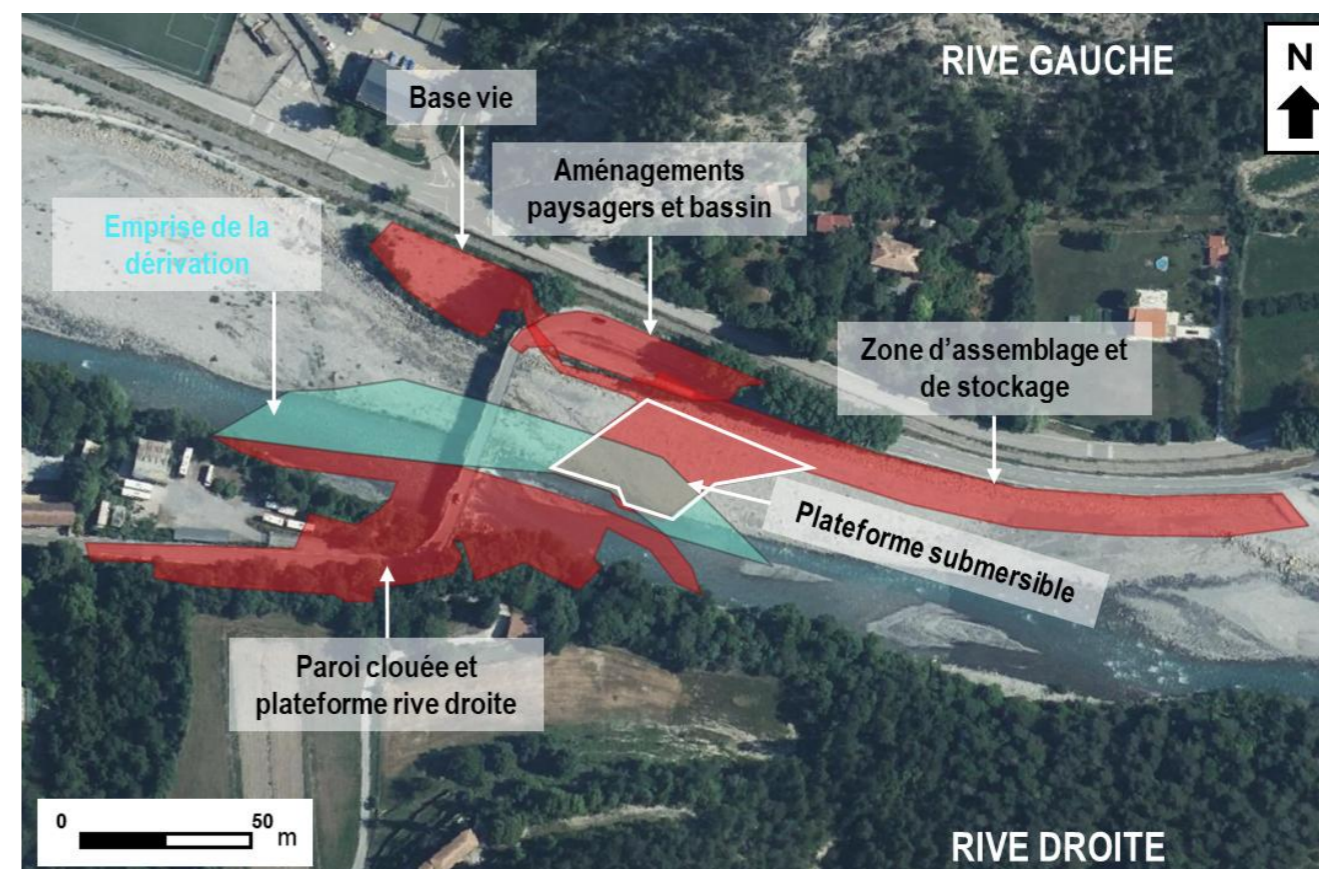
Emprise des travaux de la phase de construction sans la surface de dérivation
